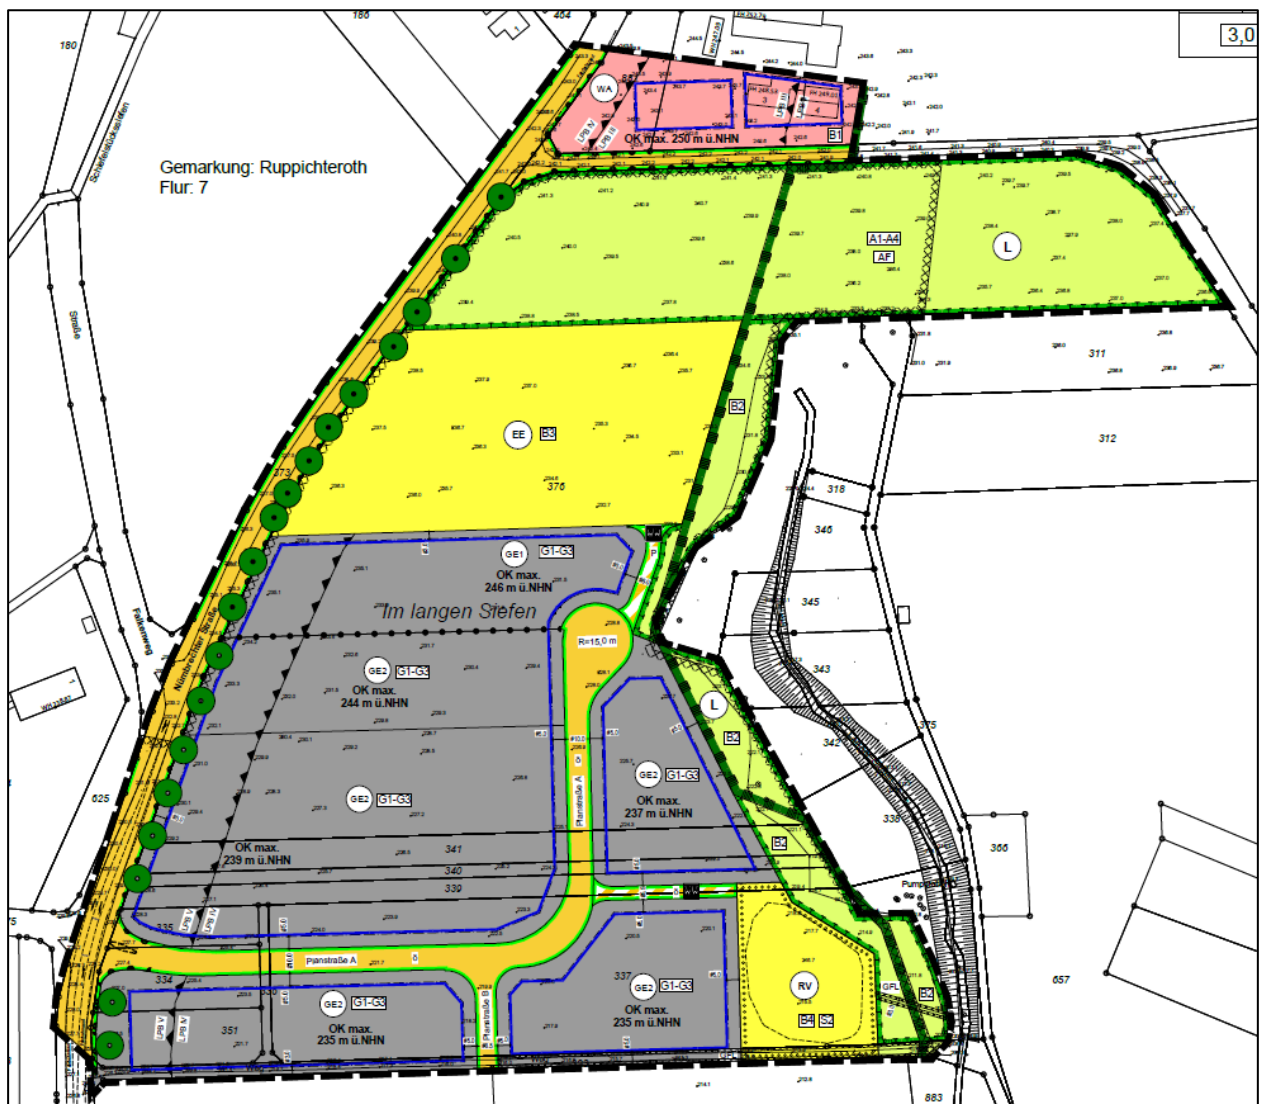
Planzeichnung Bebauungsplan, Quelle: HKS, 2025
